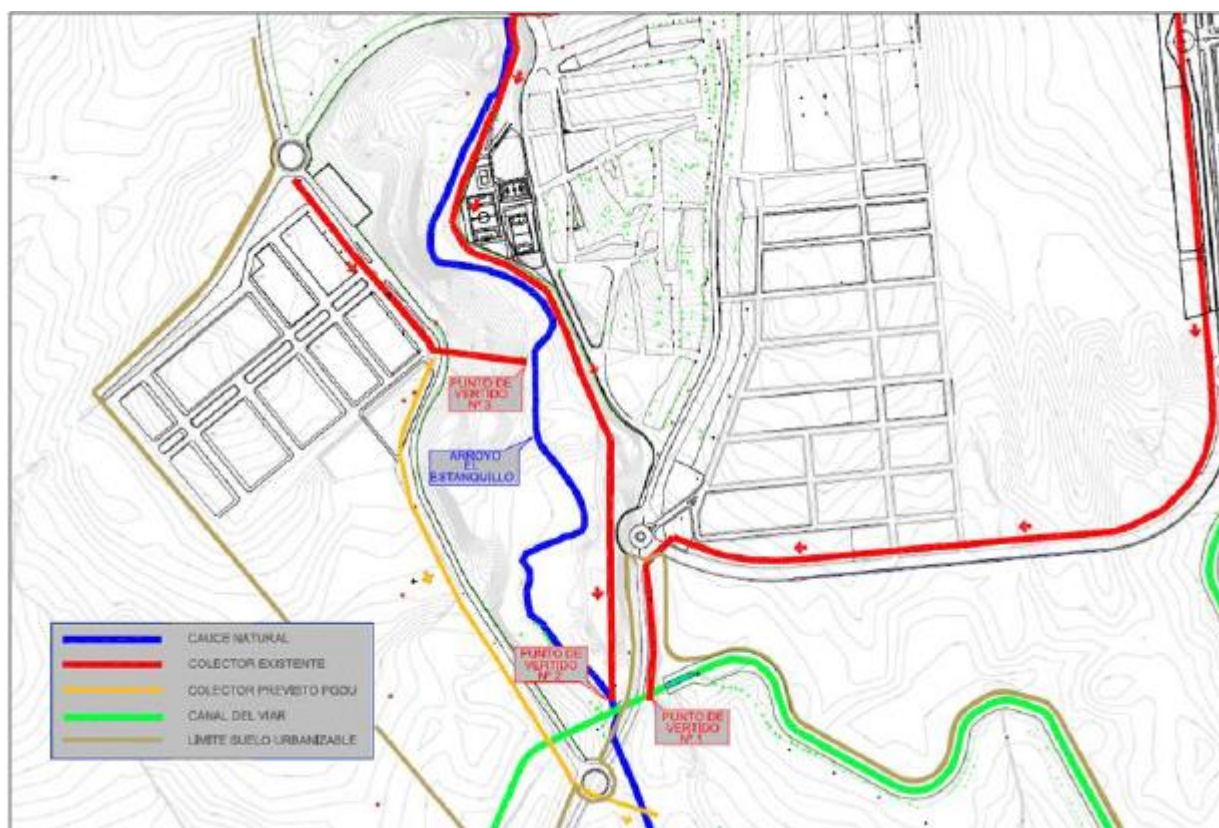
Trazado de colectores facilitado por el Ayuntamiento de Burguillos. S/E
